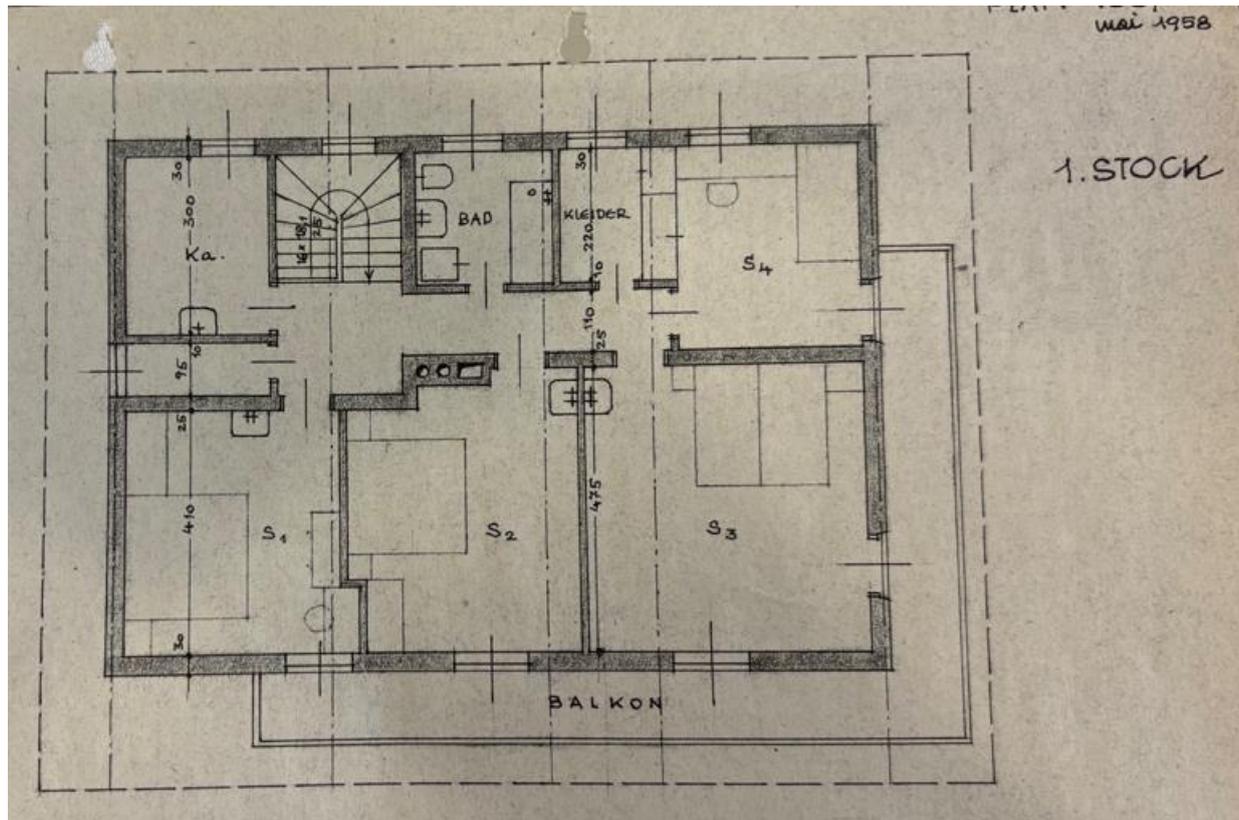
Grundriss 1. Obergeschoss
